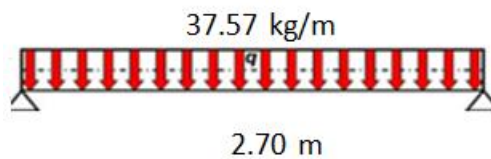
Carga distribuida en la viga segundo piso eje A entre 1-2
